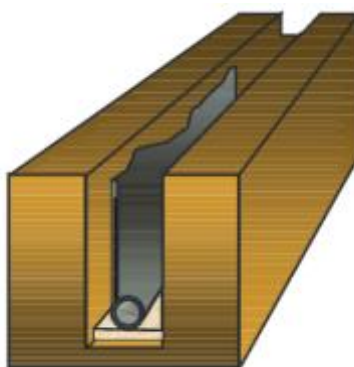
Instalación de geodren planar. Manual Pavco.
